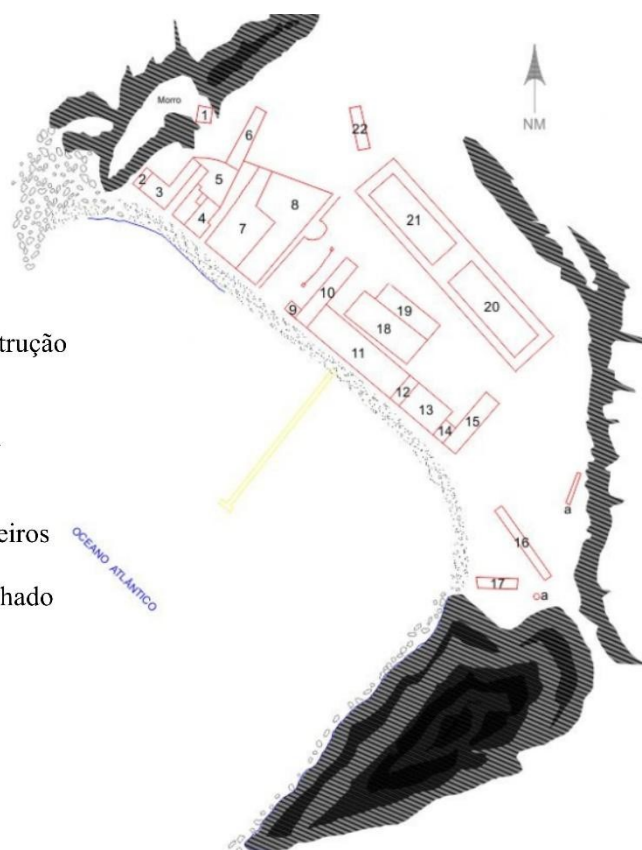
Digitalização da planta do levantamento topográfico das edificações da Armação da Piedade
